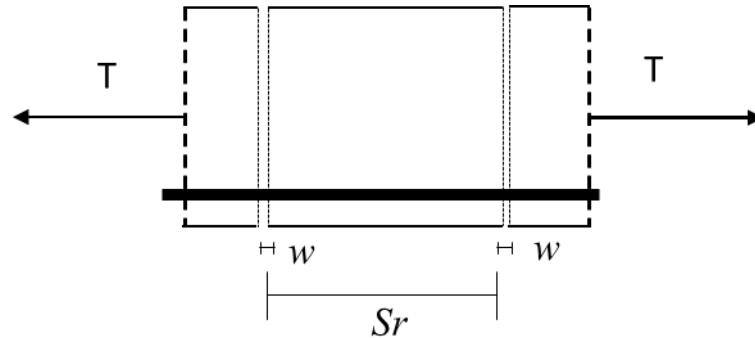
Fisuración por tracción en un elemento de hormigón.
